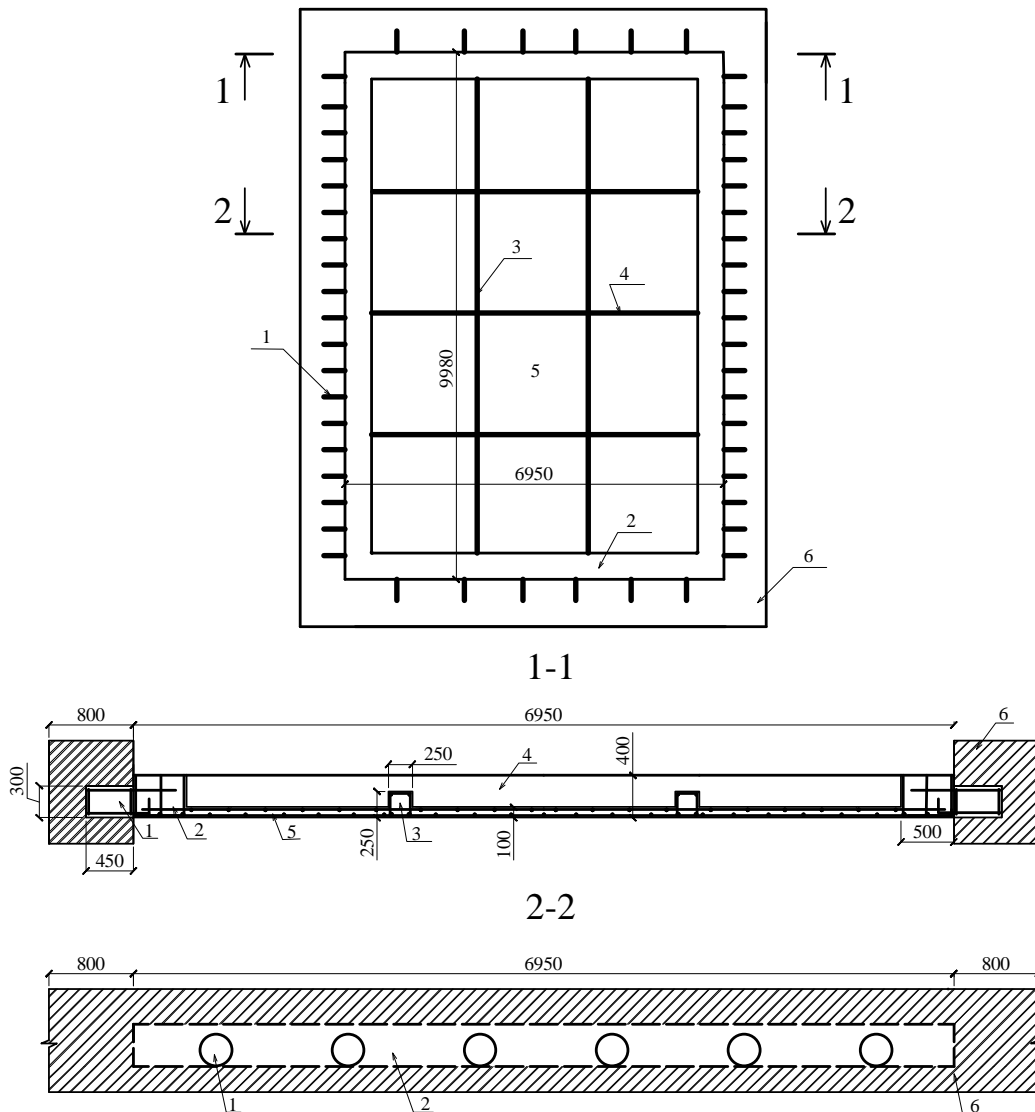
Схема виконання різновиду реконструкції фундаментної системи шляхом підведення суцільної монолітної залізобетонної плити а) вид в плані; б) розрізи 1-1, 2-2 (масштаб збільшено у два рази): 1 – круглоциліндрична консольна балка; 2 – обв’язувальна балка; 3 – другорядна балка; 4 – головна балка; 5 – плита; 6 – стрічковий фундамент
